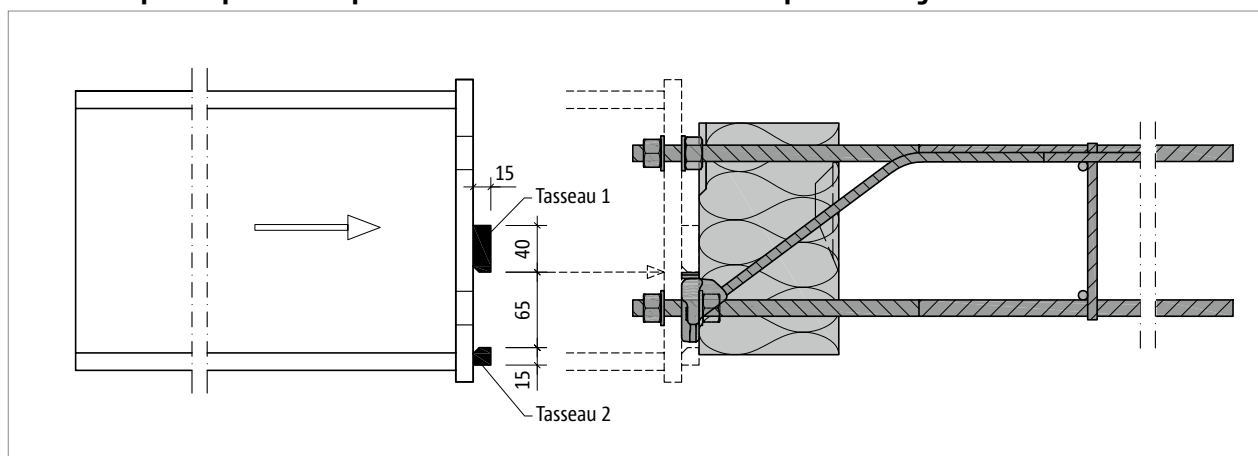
Schöck Isokorb® XT type SK : montage de la poutre en acier
